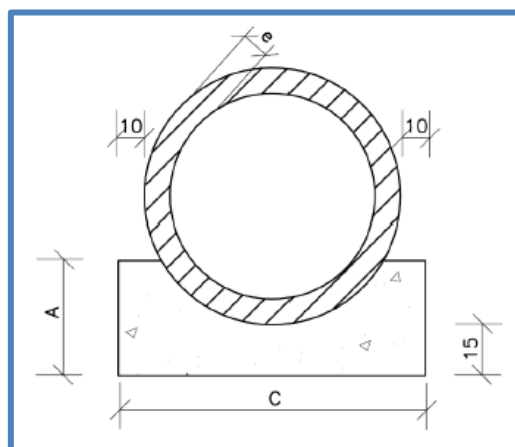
Bueiro simples tubular de concreto (BSTC)
